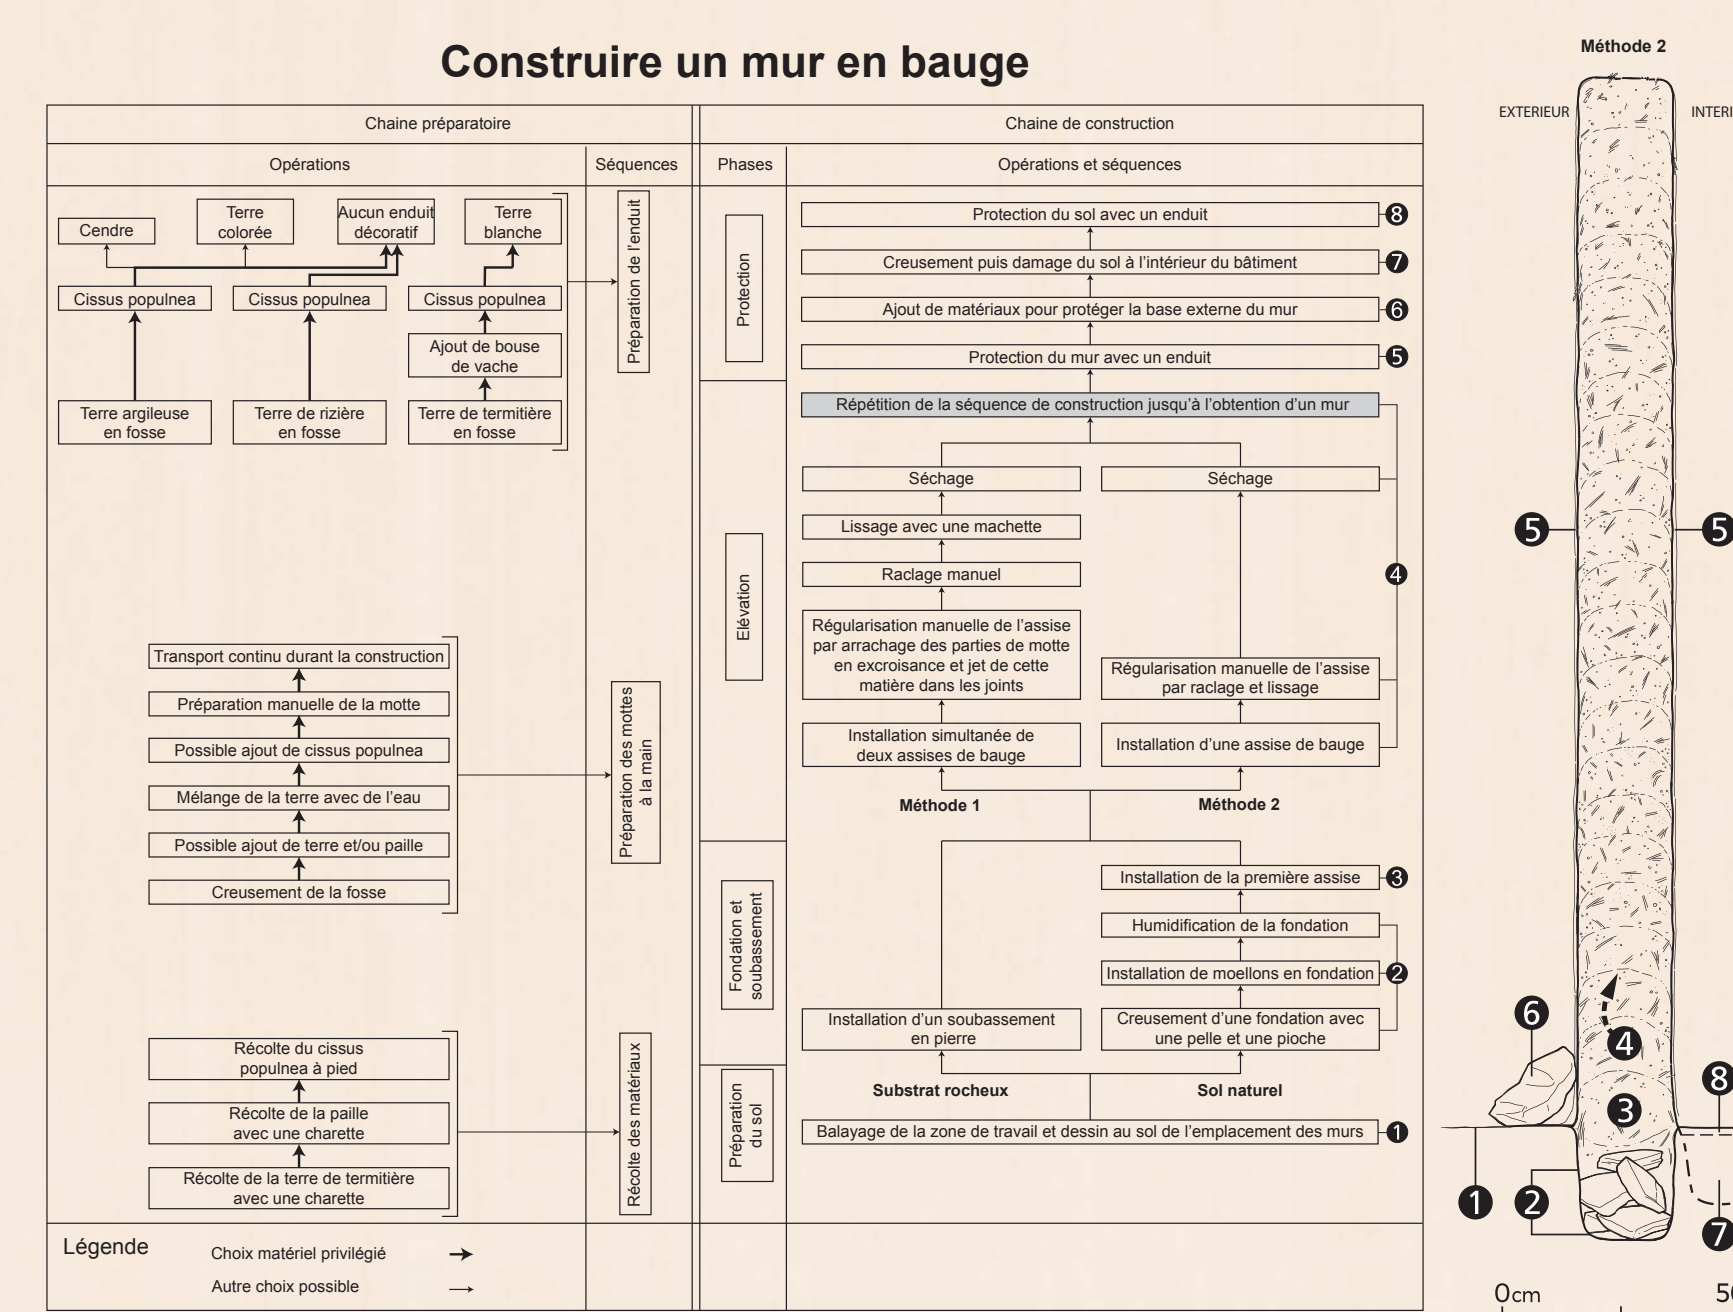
Chaîne opératoire de la construction d'un mur en bauge (dessin D. Glauser; DAO T. Pelmoine).
